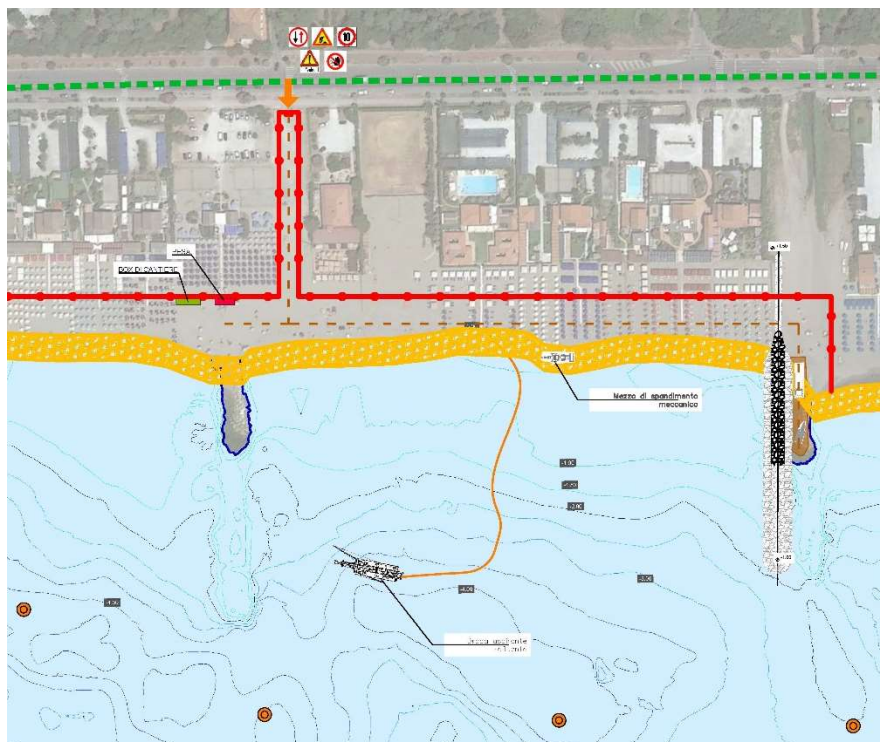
Planimetria cantierizzazione AREA B FOSSO POVEROMO
